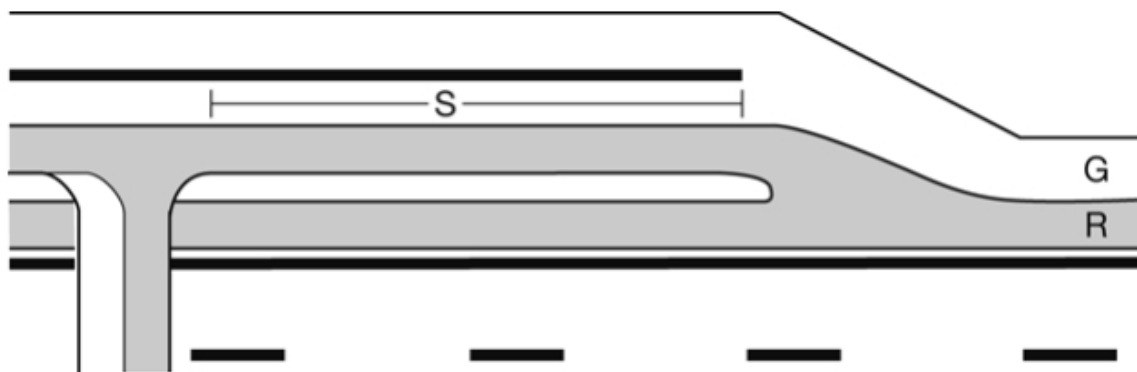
Beispiel für den direkten Anschluss der Rampe einer Überführung an den Geh- und Radweg
